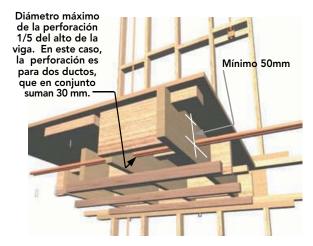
Plataforma de entrepiso que tiene perforadas las vigas secundarias.
